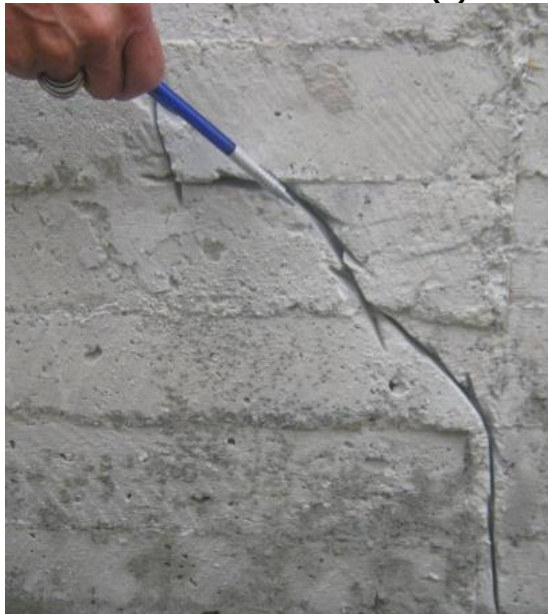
FISURA DE LA VIGA (2)
